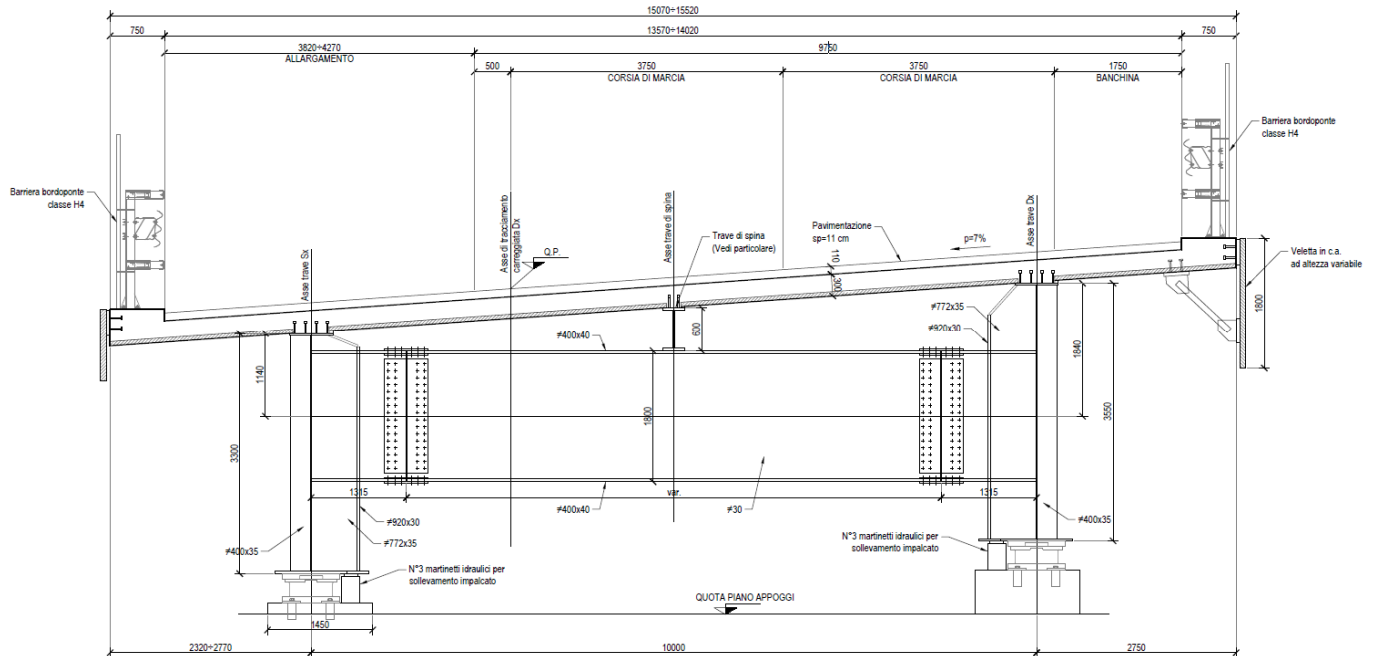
Sezione trasversale dell'impalcato su pila P1DX
